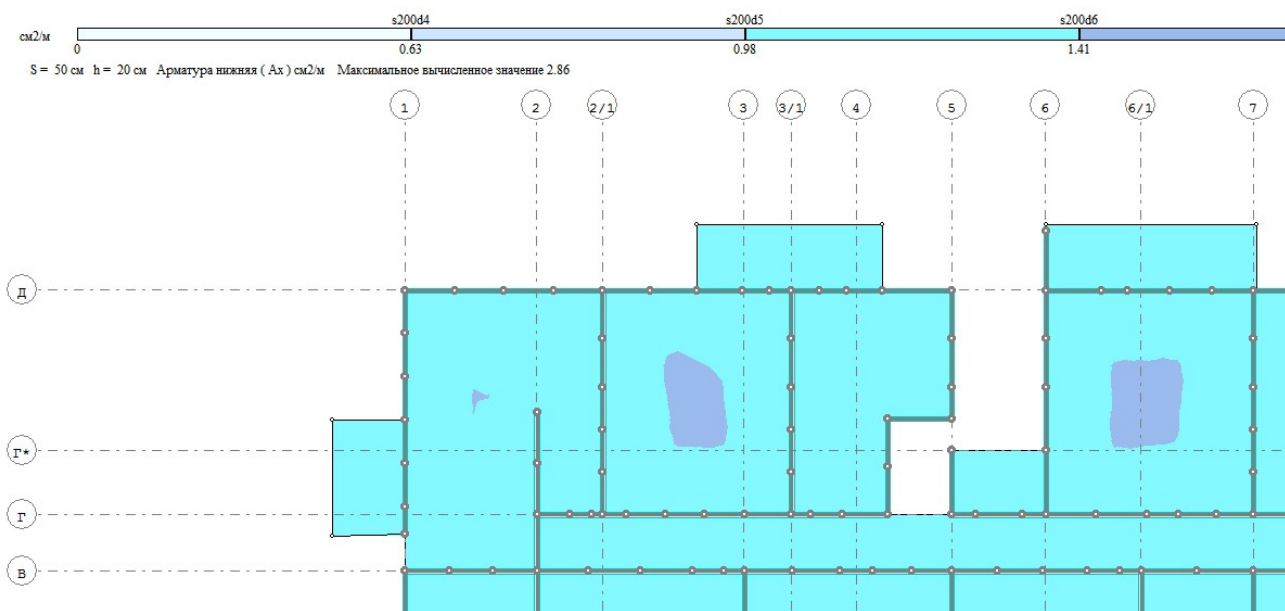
Нижняя зона армирование по оси X(см<sup>2</sup>/п.м.).
